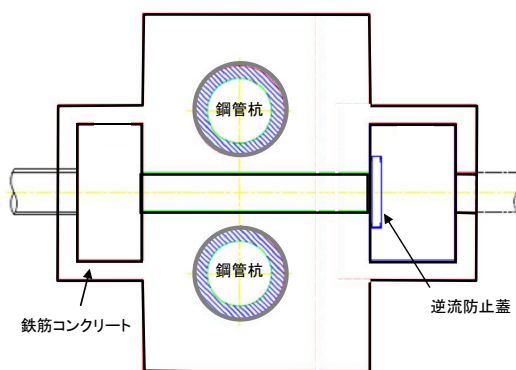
屋外排水路逆流防止設備平面図 (例)
